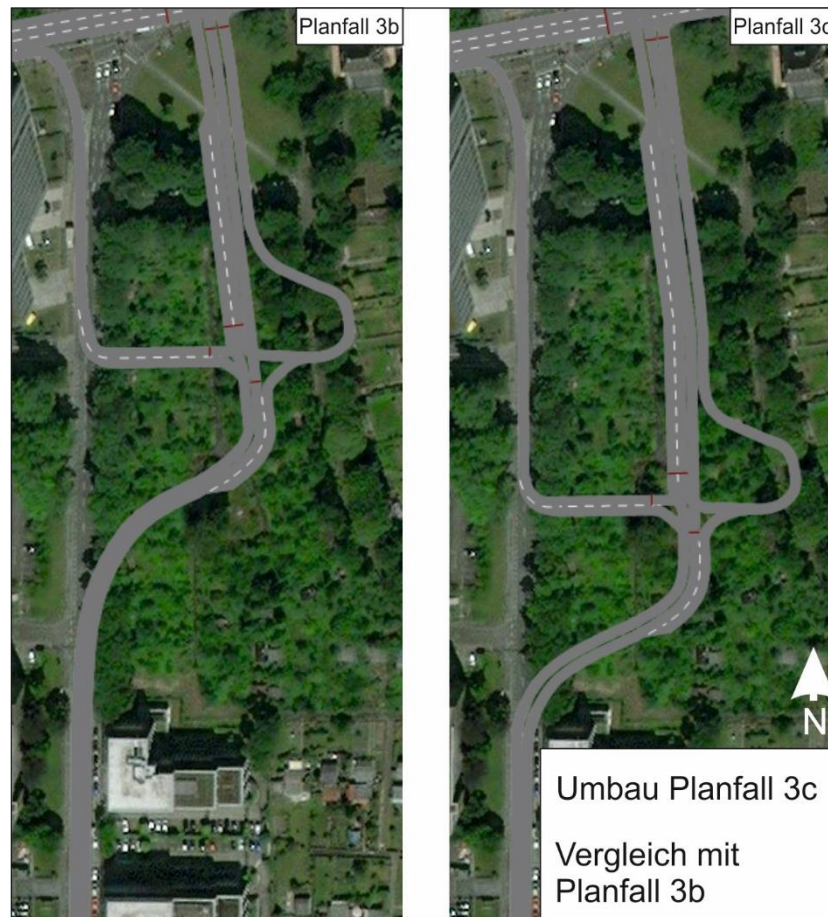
Umbau nach Planfall 3c - Vergleich mit Planfall 3b (links) [Quelle: VISSIM, Eigene Darstellung – Anhang: Umbaumaßnahmen-PF3c.jpg]
